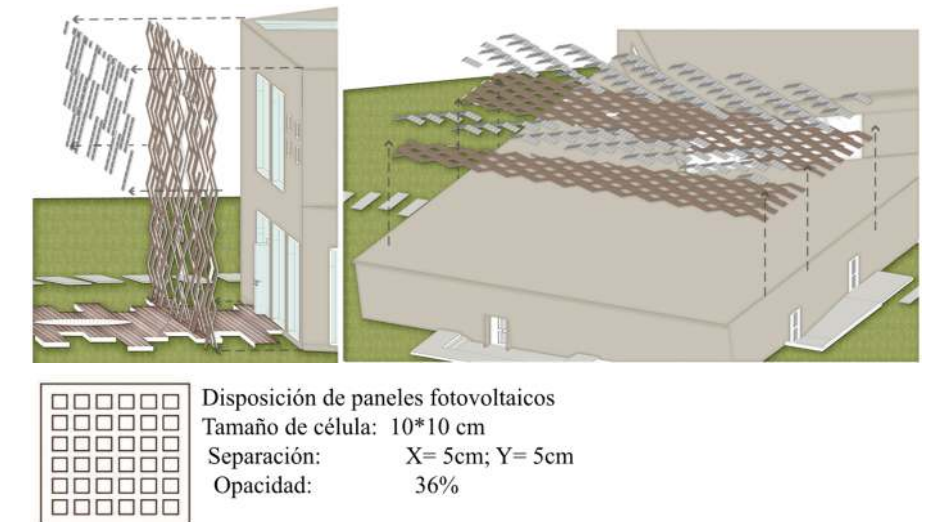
Disposición de envoltente arquitectónica y paneles fotovoltaicos en fachadas y cubierta
